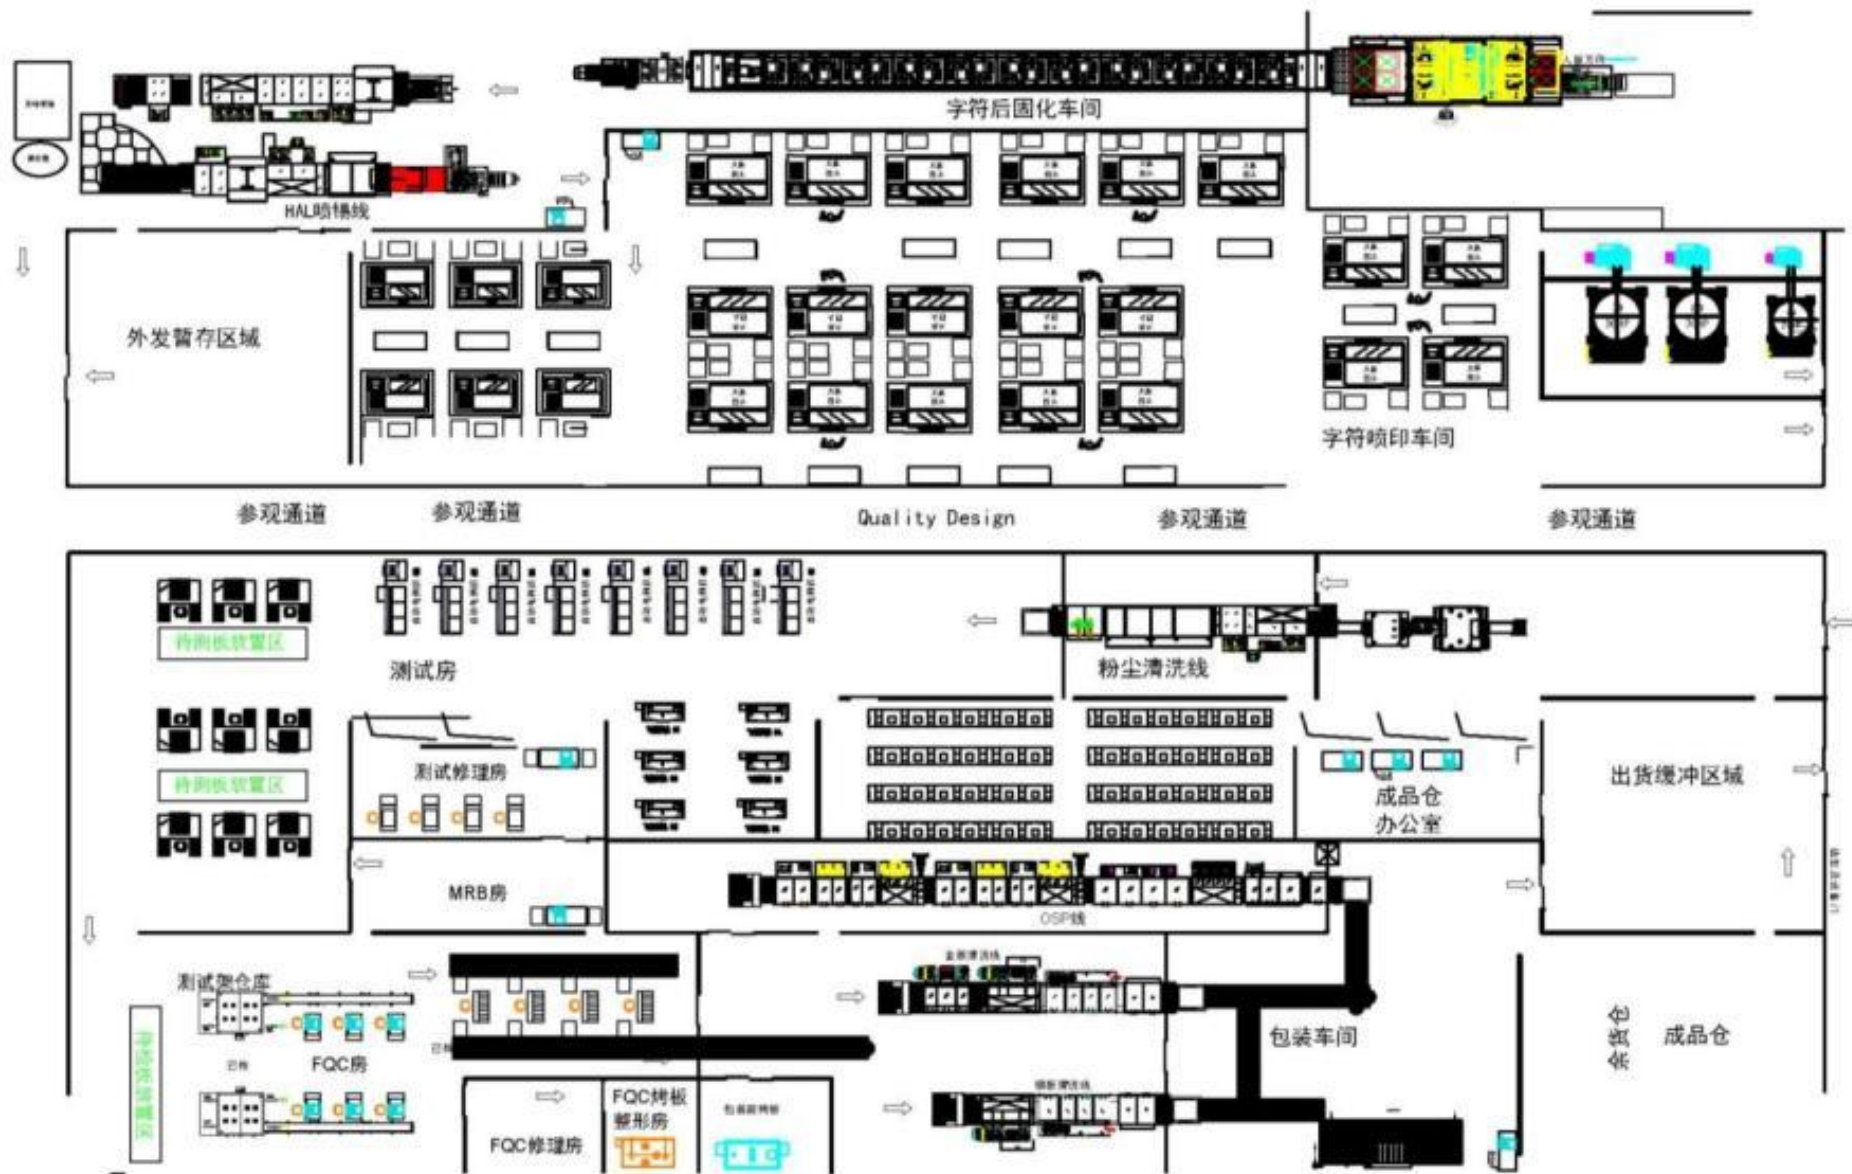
本项目二号厂房 2 楼环评阶段平面布置图
